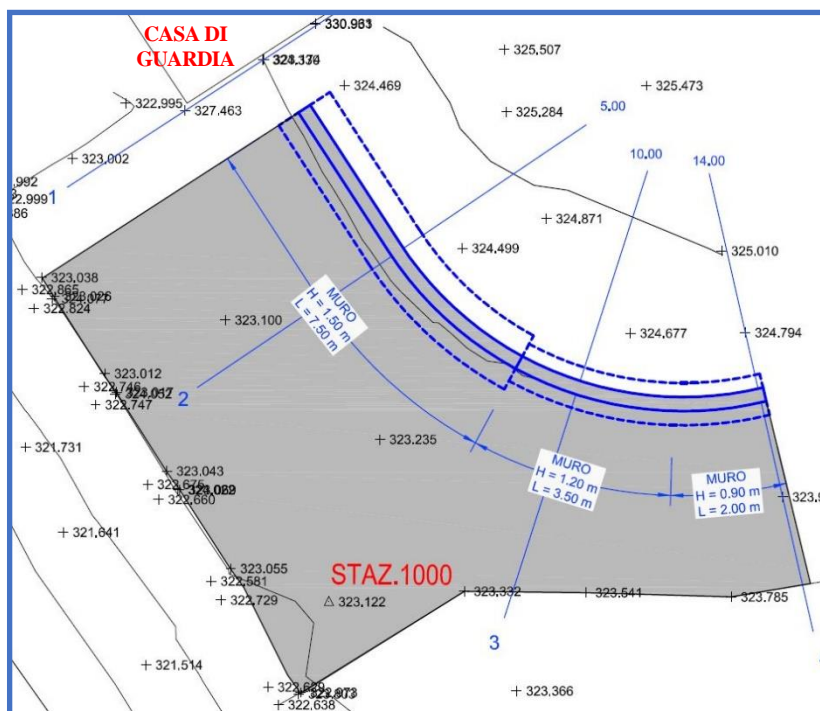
Zona intervento 3 – Planimetria dell'intervento
